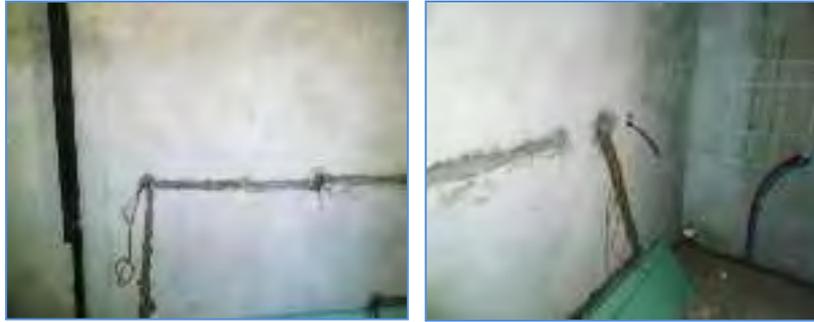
Ce type d'affaiblissement des murs en béton armé est interdit en zone sismique. (Source ANCO)
